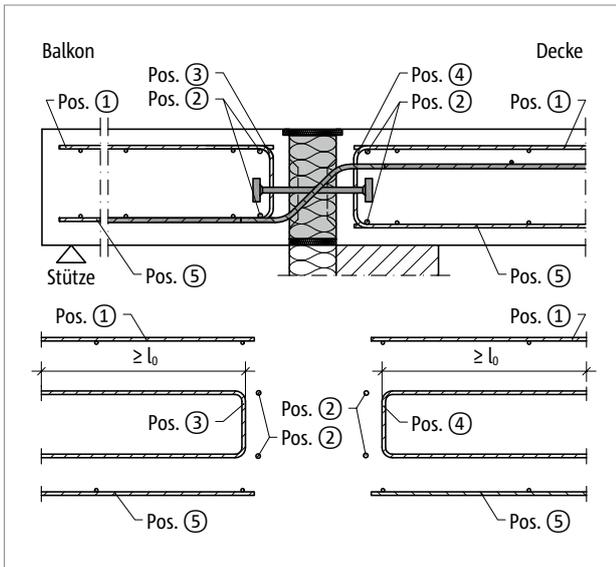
Schöck Isokorb® T Typ Q-P: Bauseitige Bewehrung
